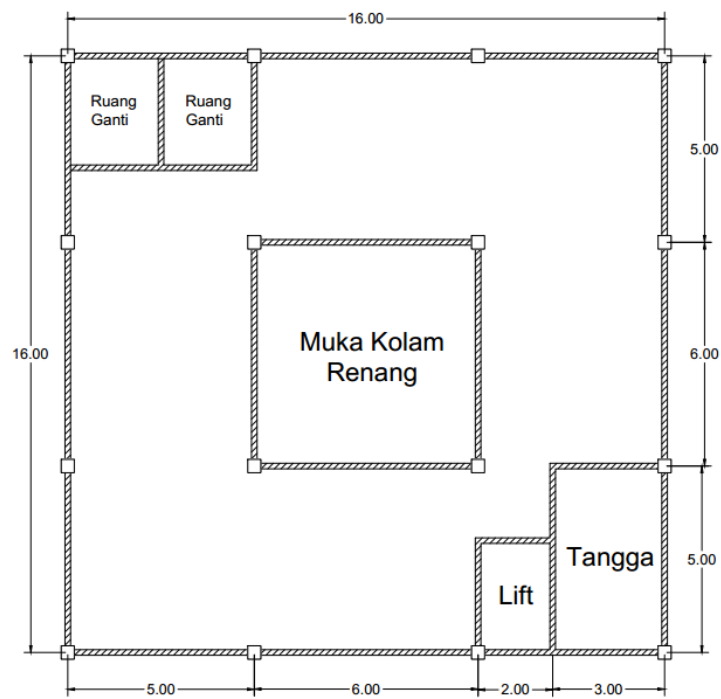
Denah Lantai 1 (*Lobby*)
